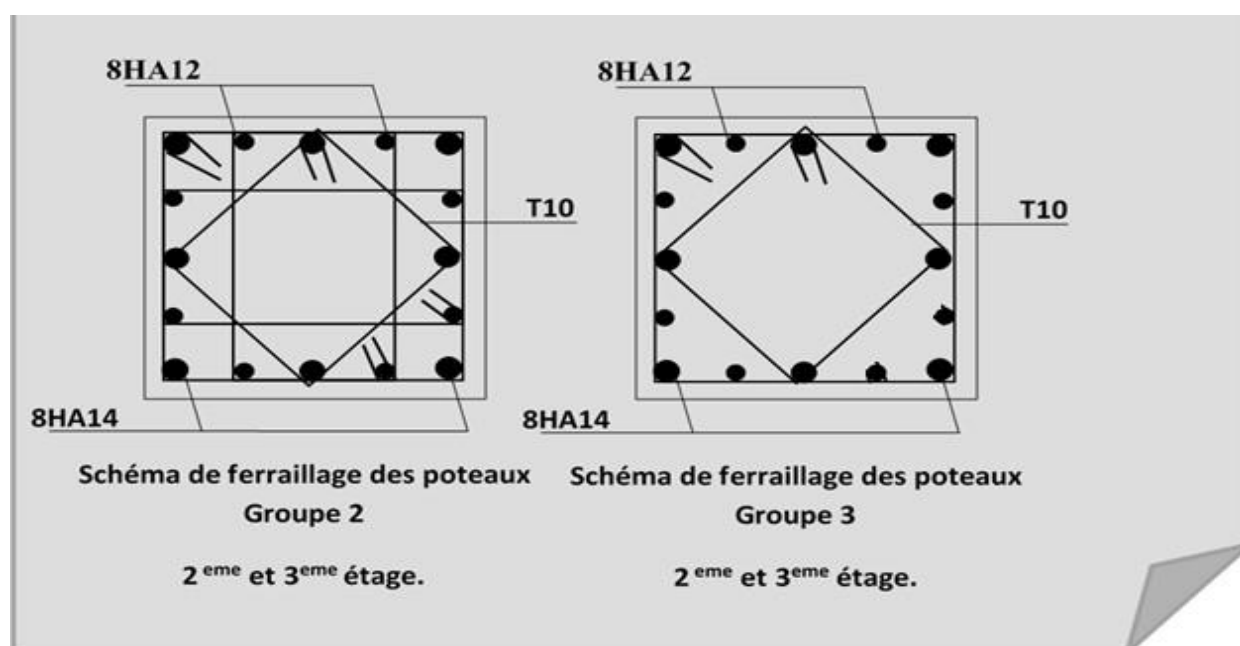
Schémas de ferrailage des poteaux 2^{eme} et 3^{eme} étages
